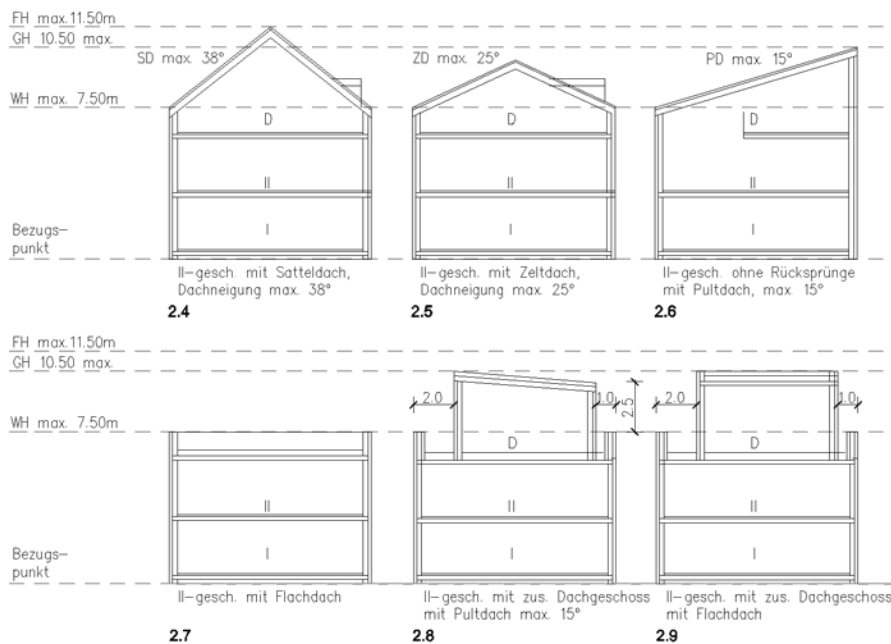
Beispielhafte Darstellung von Wand- und Gebäudehöhen in Verbindung mit den Dachformen, die gem. örtl. Bauvorschrift zulässig sind:
